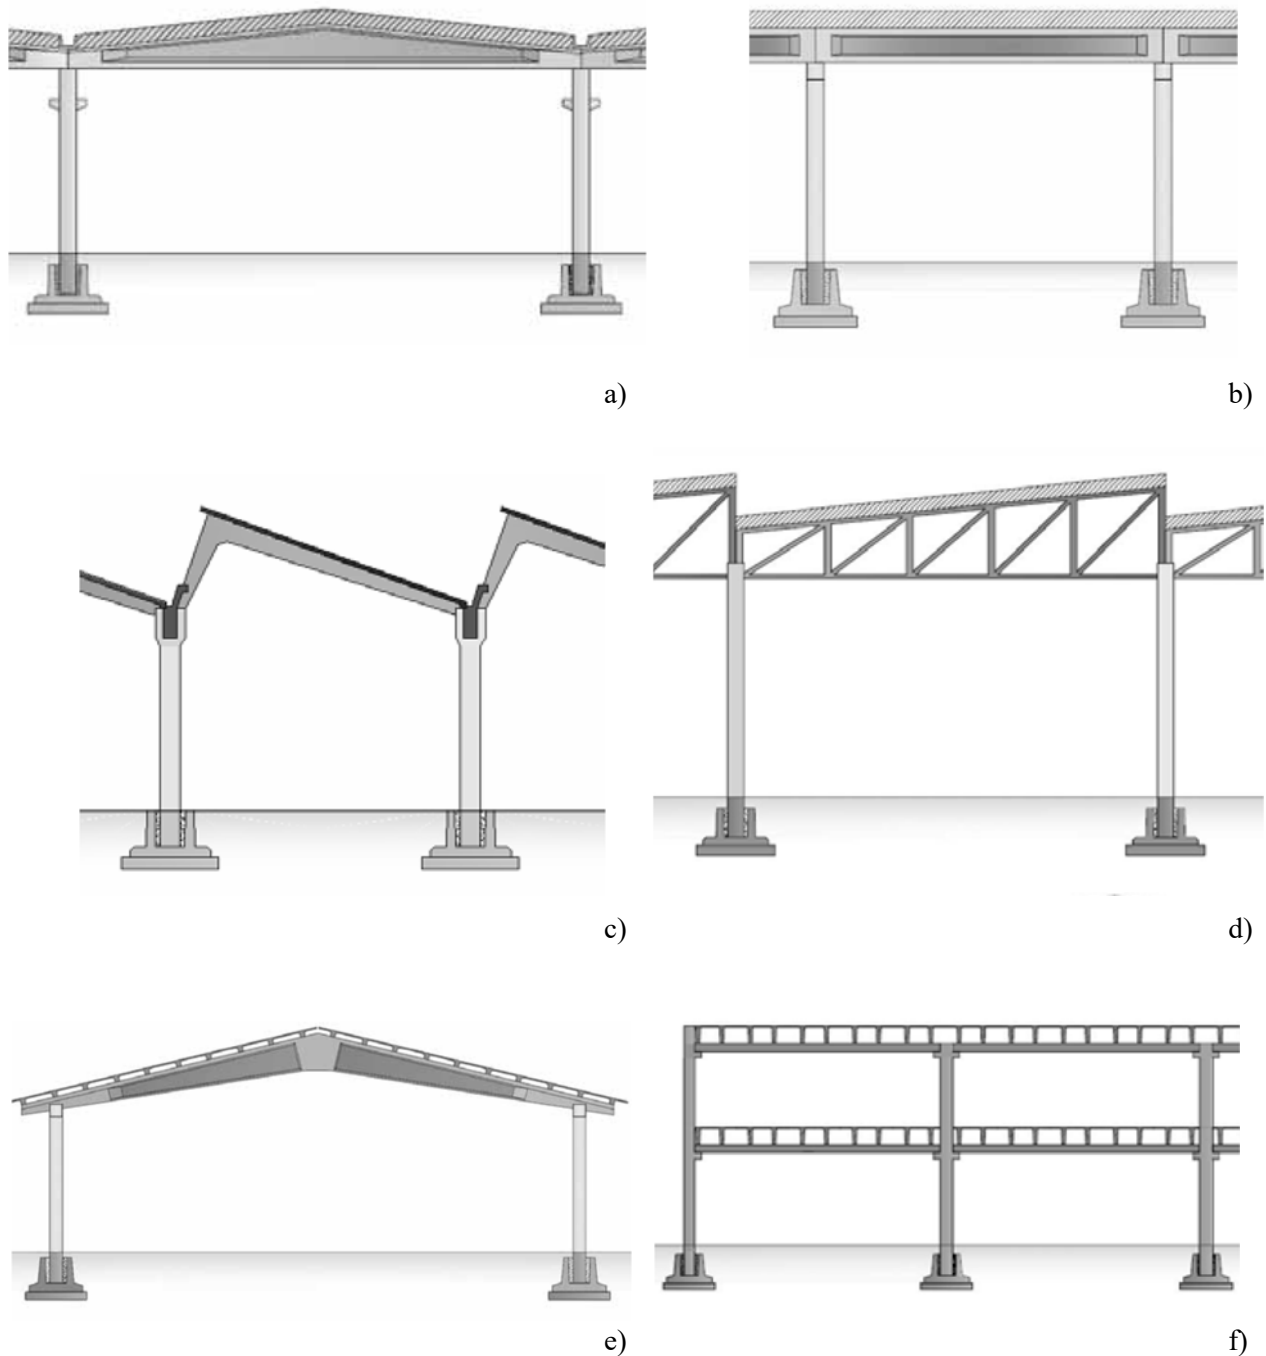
Principali tipologie di strutture prefabbricate utilizzate in Italia (da Reluis 2008): a) Travi a doppia pendenza; b) Coperture piane; c) Coperture a shed; d) Coperture reticolari; e) Coperture con travi a boomerang; f) Strutture multipiano con pilastri a mensola
